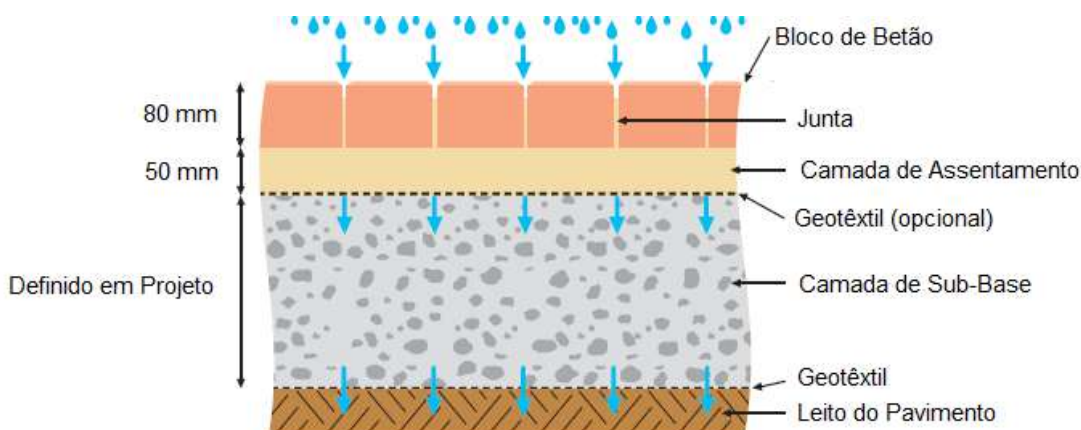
Pavimento permeável tipo A – Infiltração total (INTERPAVE, 2010)
